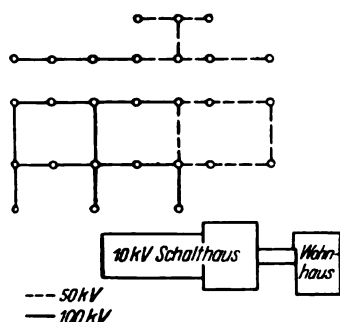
Lageplan der Umspannanlage Neubeckum (Westf.).
